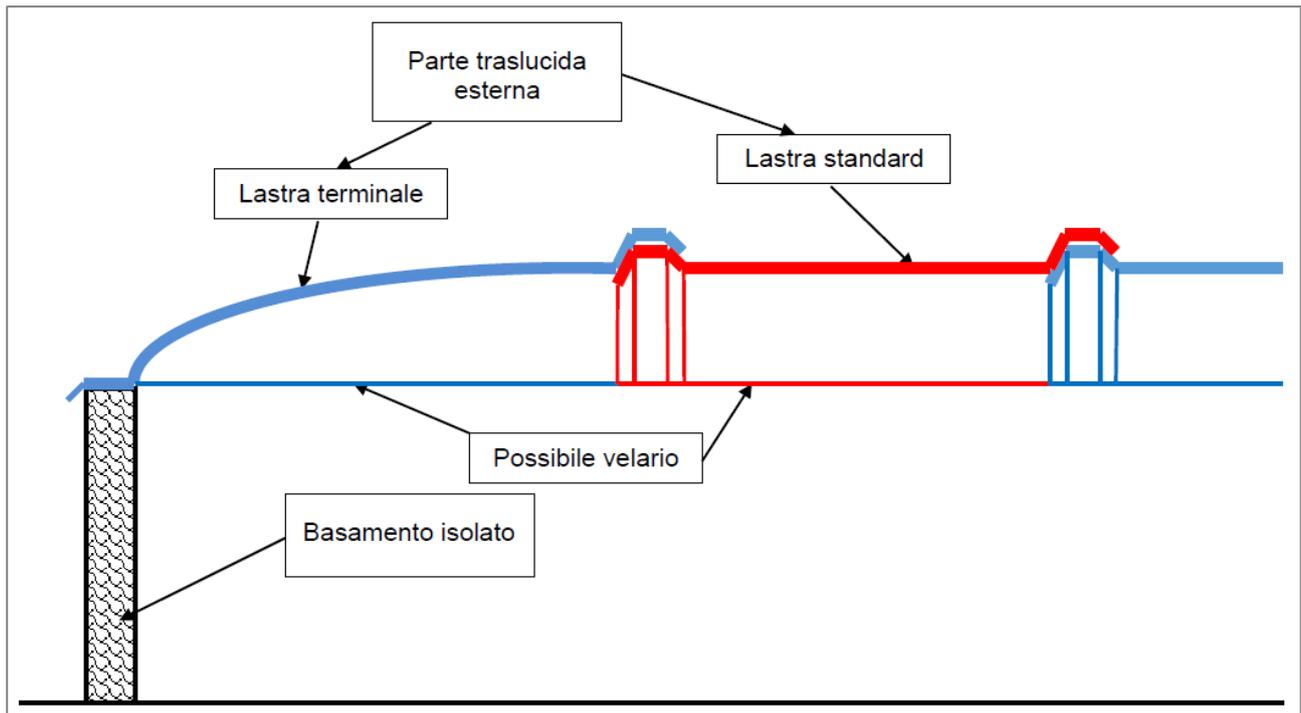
Sezione longitudinale del Lucernario termoformato fisso
